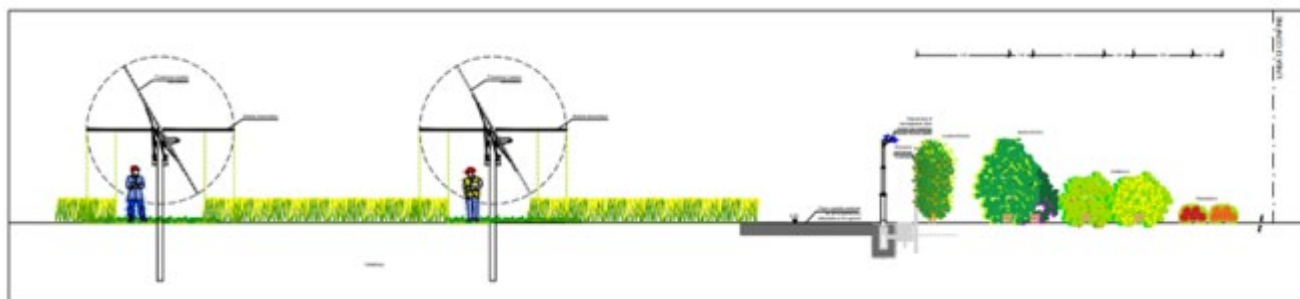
Sezione impianto con particolare della fascia di mitigazione
